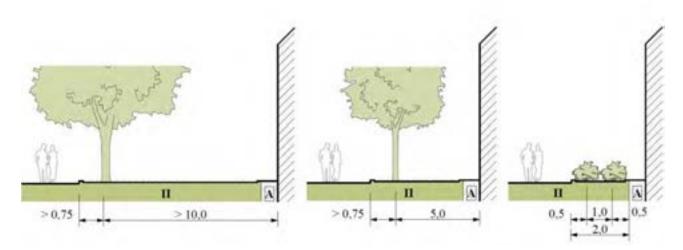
Принципиальные схемы размещения зеленых насаждений по отношению к фасаду здания
